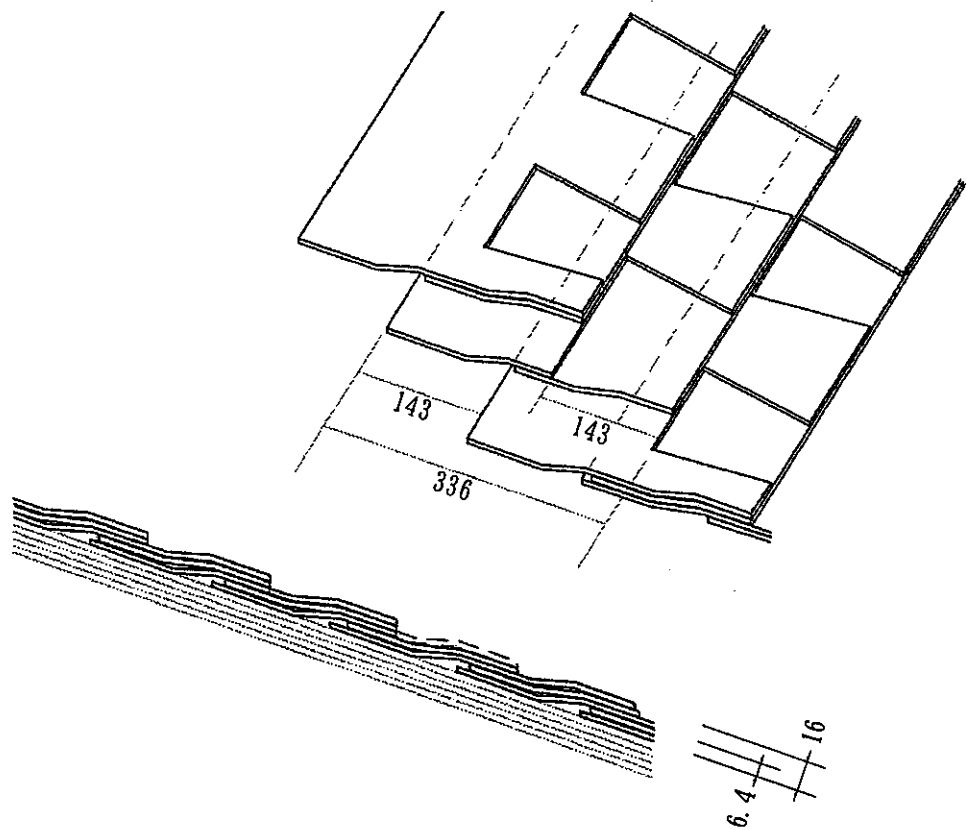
申請仕様の施工図 (アスファルトシングルの施工: コンポジットタイプ)
